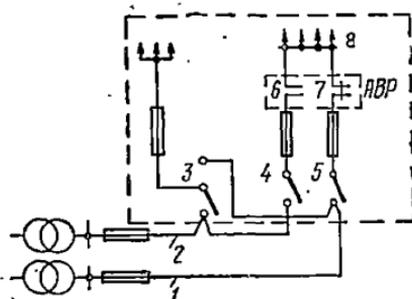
Схема питания жилого дома высотой 16 и более этажей
